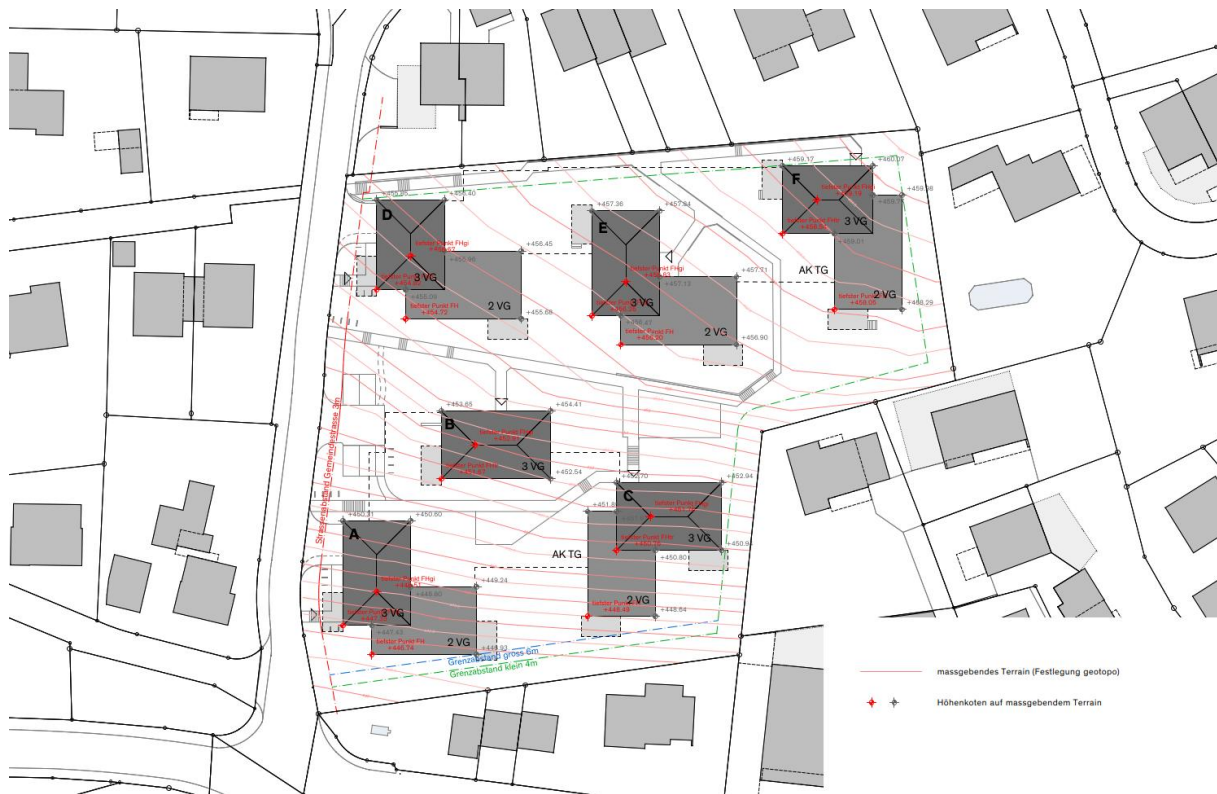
Höhenkoten, Fassadenhöhen, AKKURAT AG
